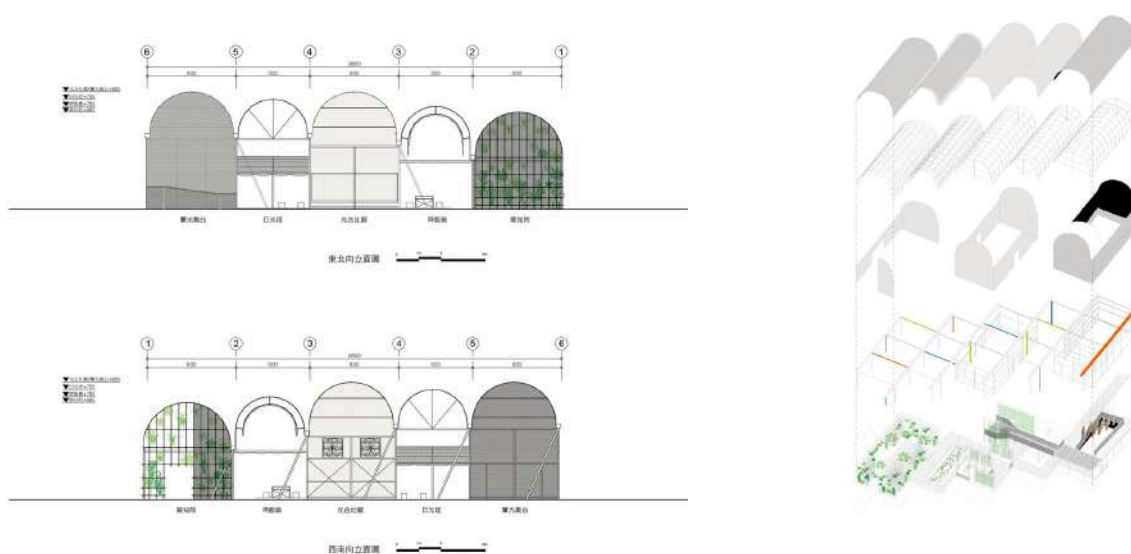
Фасади та вибух-схема Greenhouse as a home [14].
